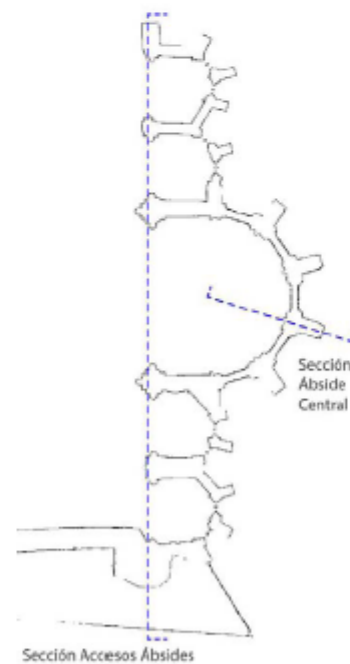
Secciones de control en fachada de acceso ábsides y ábside central (3).
